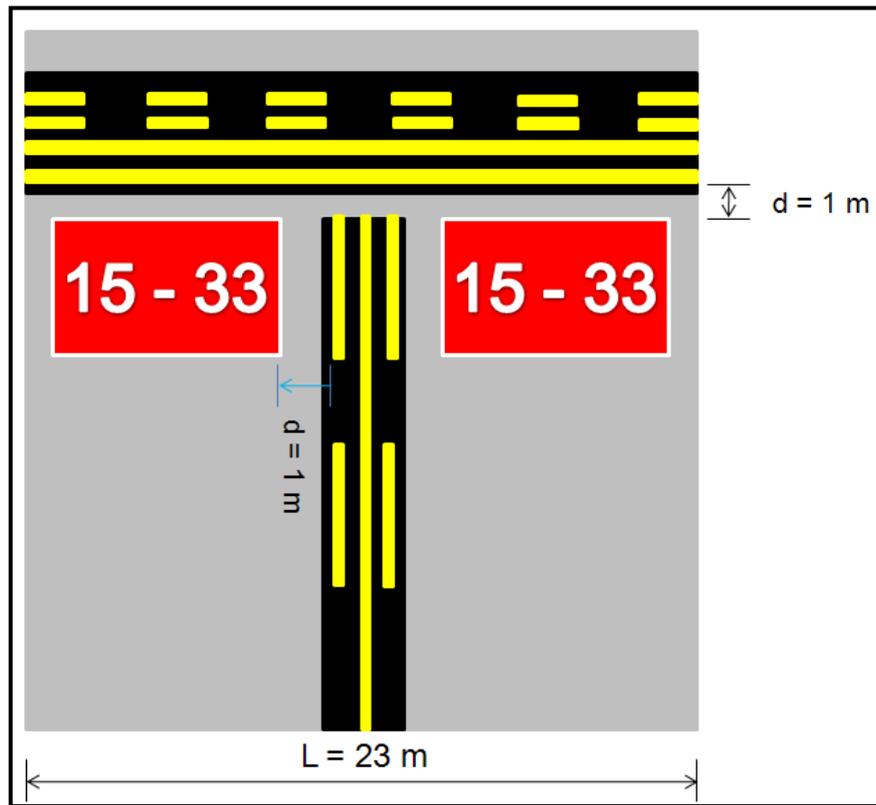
Sinalização horizontal de instrução obrigatória pintada numa pista de táxi com largura de 23 m (RBAC 154.303(p))
